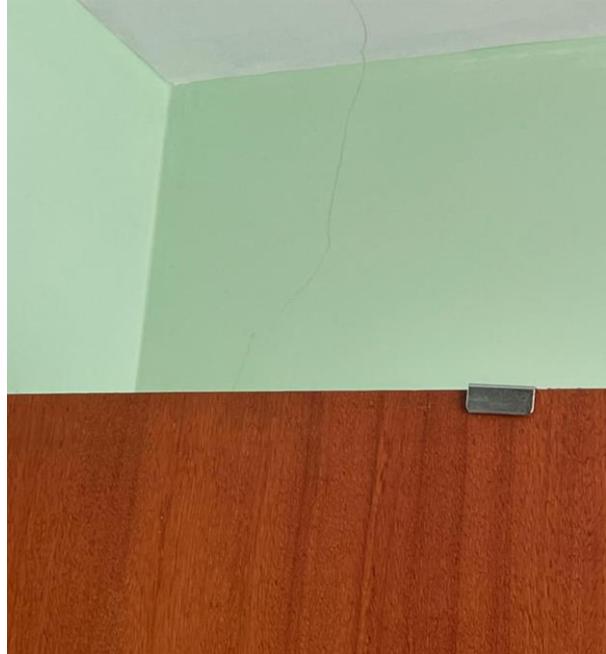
Apartamento 302 e do bloco B - fissura na alvenaria.
